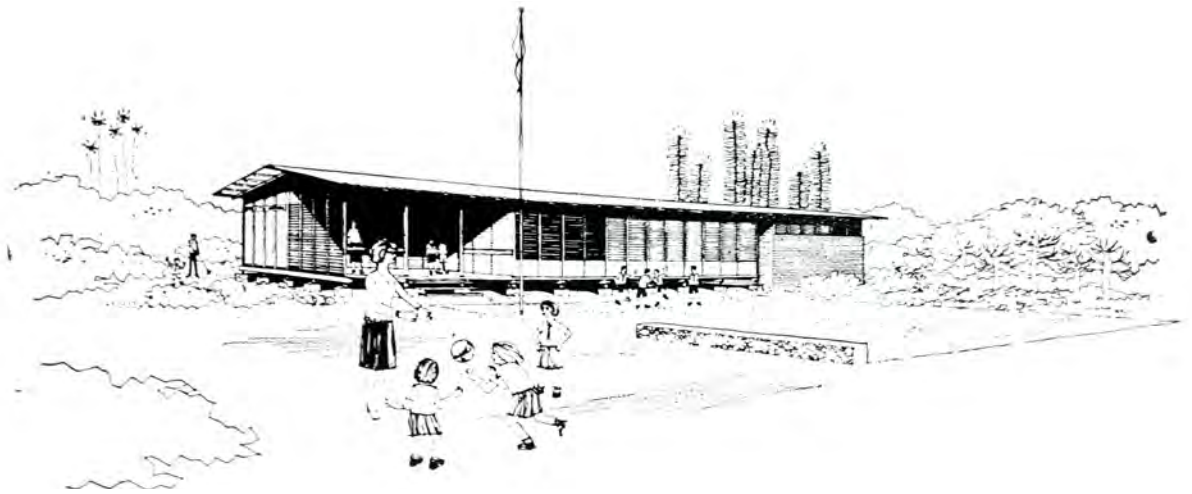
Escolas pré-fabricadas | Croquis, 1965
